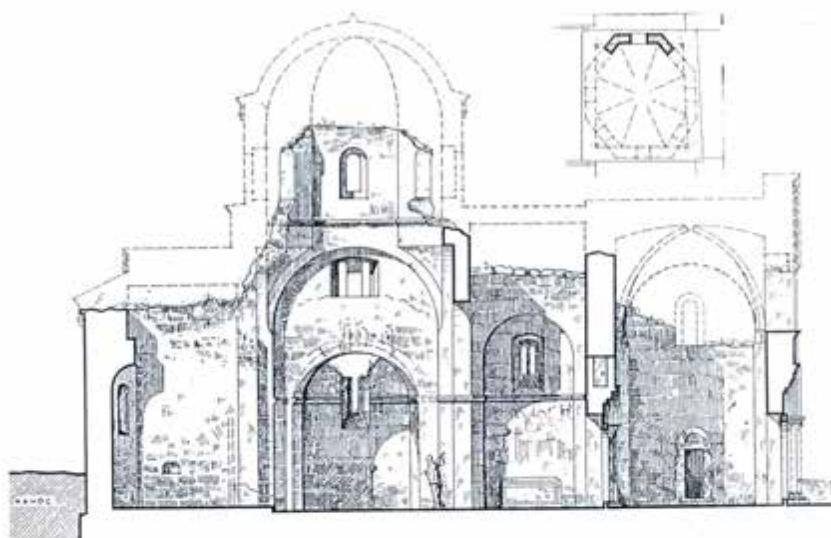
Chiesa della Madre di Dio, pianta e sezione longitudinale, monastero Gradac (da Nenadović 1980)
